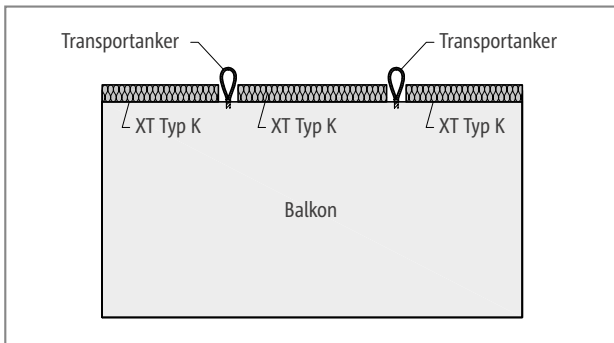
Schöck Isokorb® XT Typ K: Elementbalkon mit Transportanker; Dämmzwischenstück XT Typ Z kann bauseitig eingelegt werden
